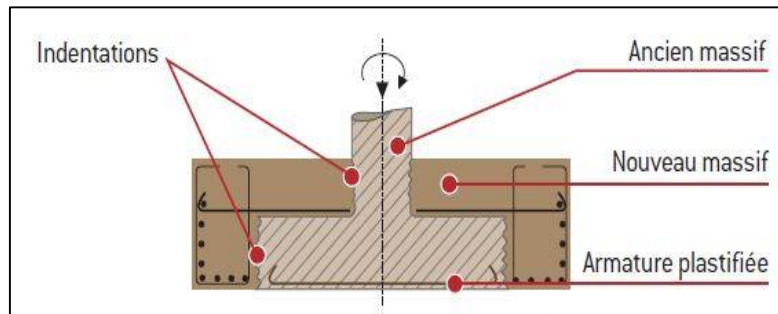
renforcement d'une fondation avec surépaisseur de la semelle
